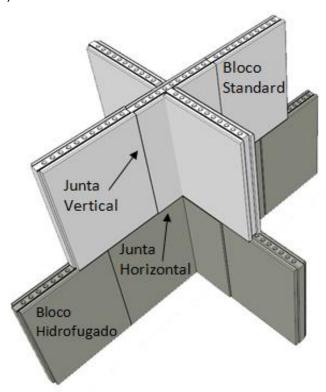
Detalhe do encontro entre paredes com amarração cruzada
